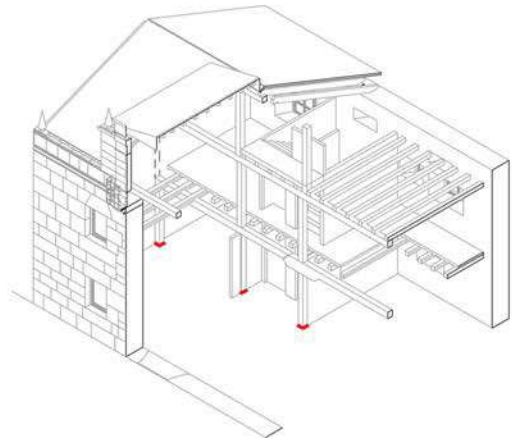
Axonomería los pies derechos con falta de apoyo Fuente: Elaborado por el autor
